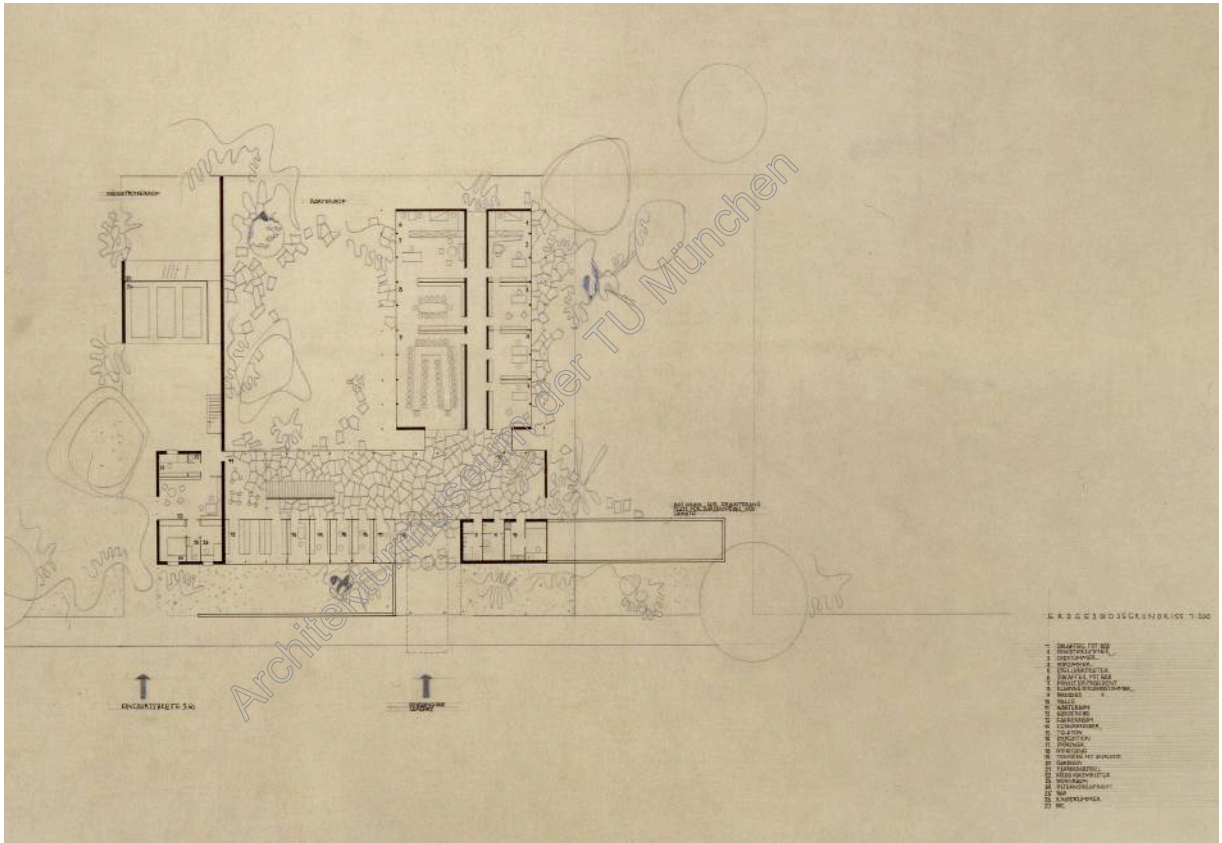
Wettbewerbsbeitrag von Sep Ruf. Grundriss Erdgeschoss. Hier liegen Haupteingang und Pavillonflur noch nicht in einer Flucht. Anhand der mit nur einem dünnen Strich gezeichneten Glasfassaden und dem „Ausfließen“ des polygonalen Plattenbelages in den Garten wird Rufs Intention der Verknüpfung von innen und außen deutlich. Massive Wände sind bewusst und äußerst sparsam eingesetzt. Bild: Architekturmuseum der TU München.
